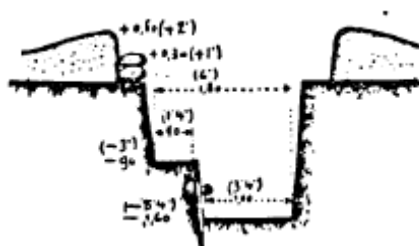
Profil spojovacího zákopu s vypouklým dnem
